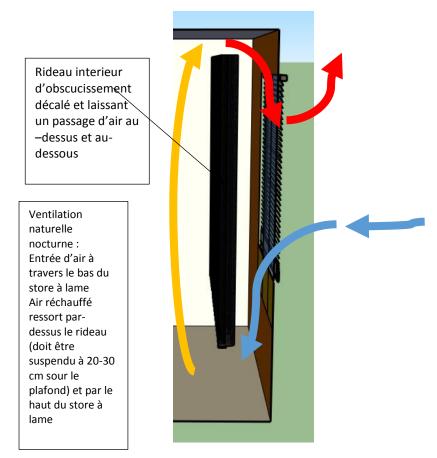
Vue en coupe d'un système de ventilation naturelle nocturne avec obscurcissement par un rideau intérieur suspendu à 20-30 cm du plafond et avec sa partie basse à environ 30 cm du plancher
